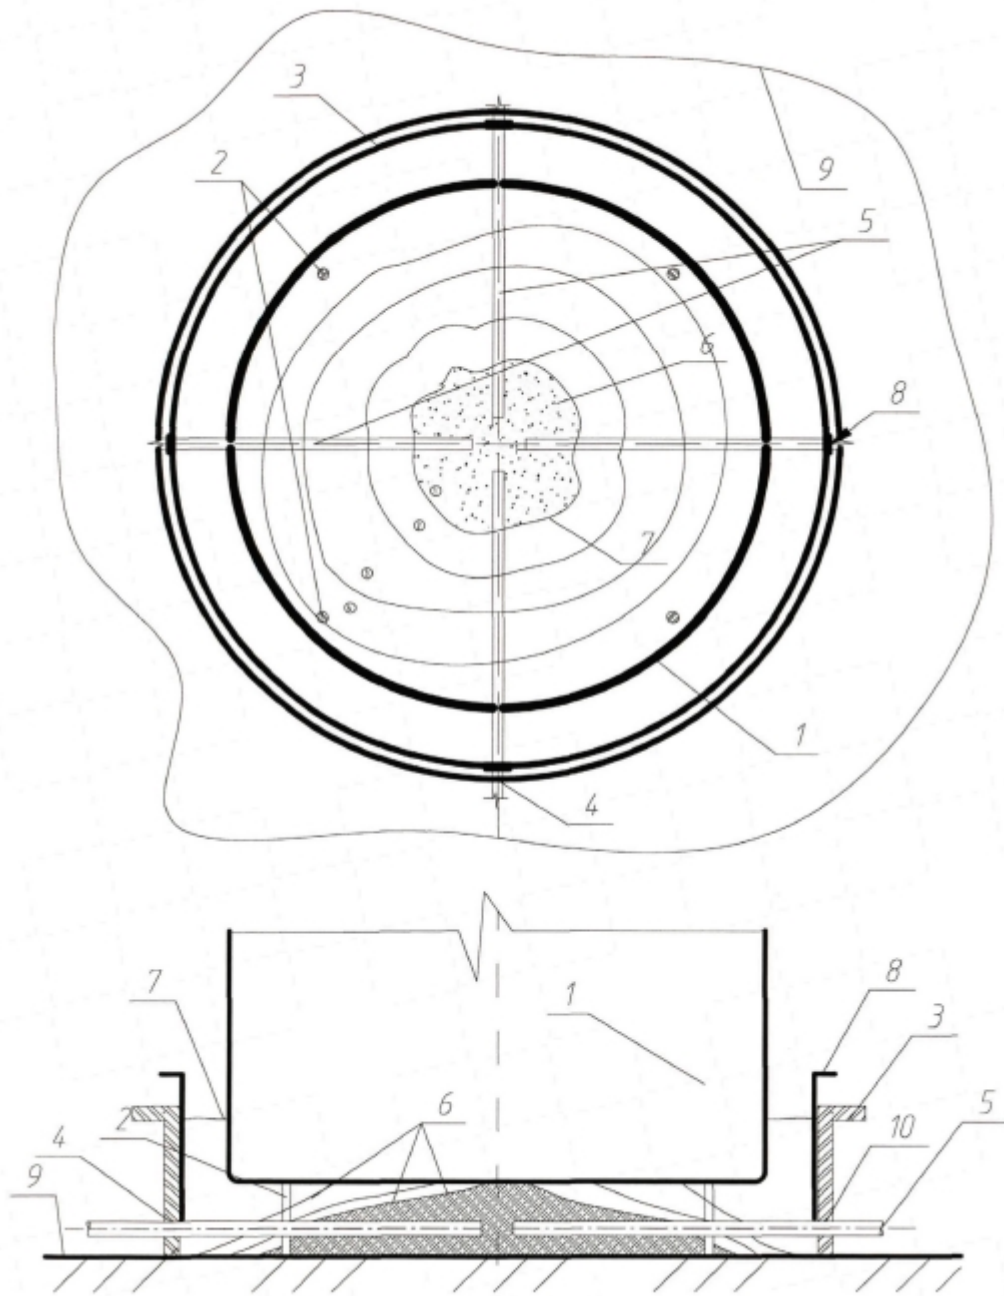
а - Схема бетонування порожнини з центру нагнітальним методом: 1-обладнання; 2 - опори; 3 - опалубка; 4 - отвори в опалубці під бетоноводи; 5 - бетоноводи; 6 - бетонна суміш; 7 - рівень бетонування (підпору); 8 - заглушки; 9 - підстава; 10 - ущільнювач
